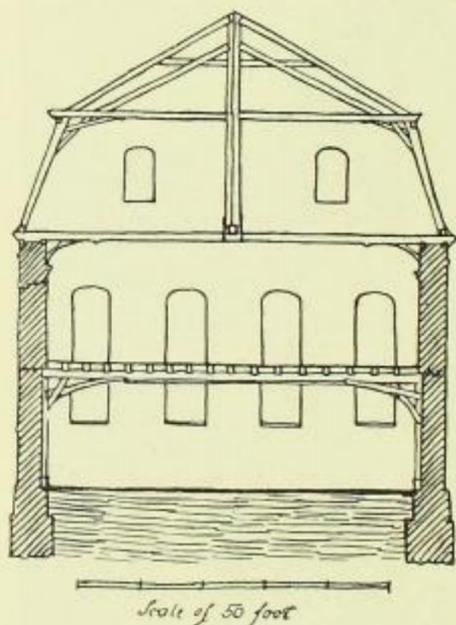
Herrnhut, Gemeinhaus. Querschnitt durch den Orgelchor; nach altem Plan.
